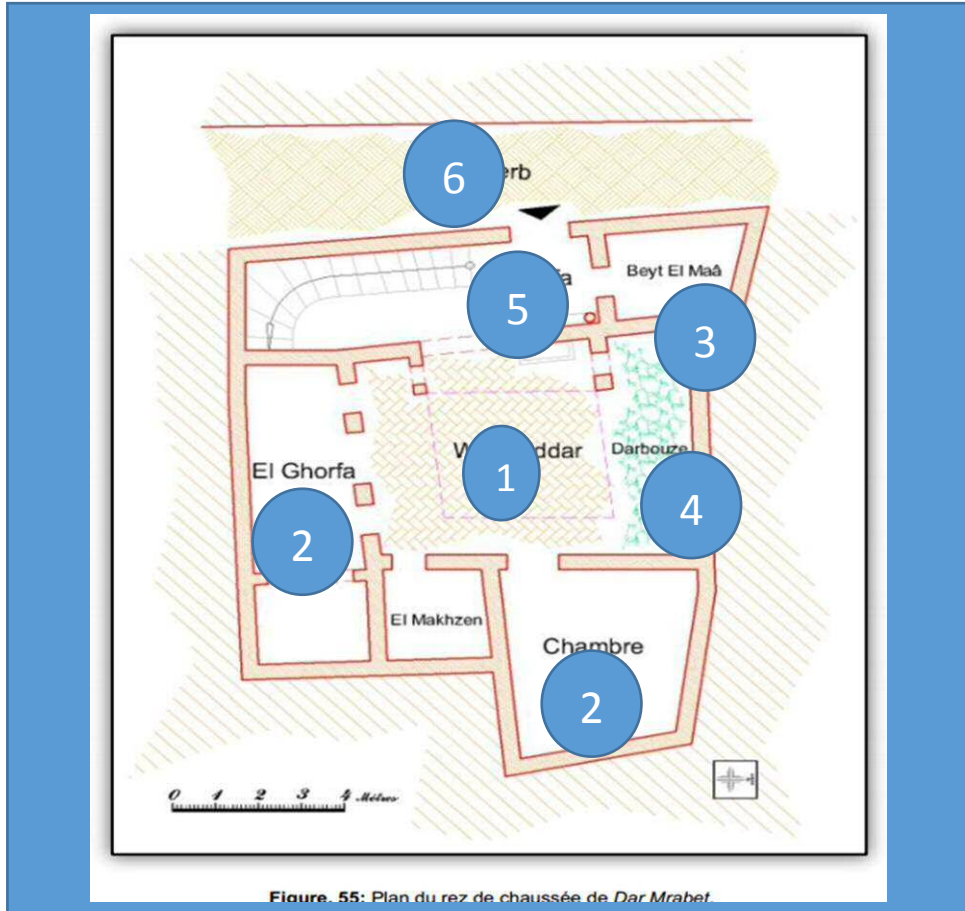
Plan du rez de chaussée de Dar Mrabet.
